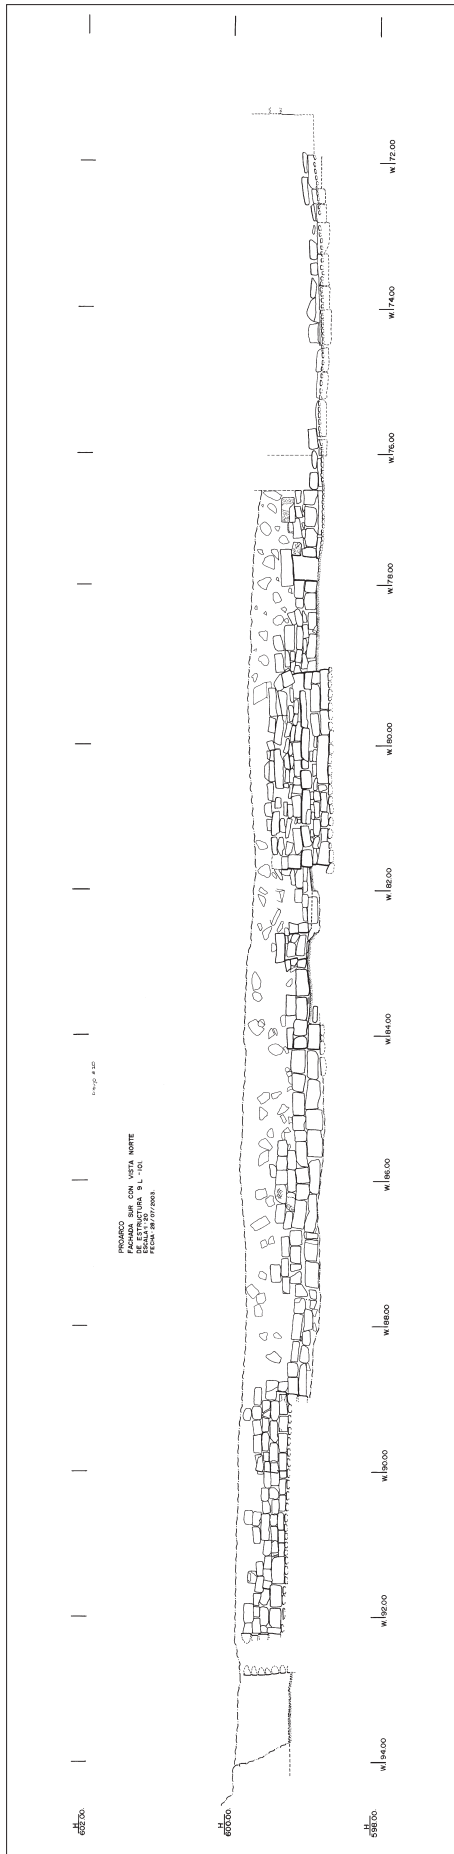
Fachada del basamento de 9L-101-1^a y los anexos, vista al norte
